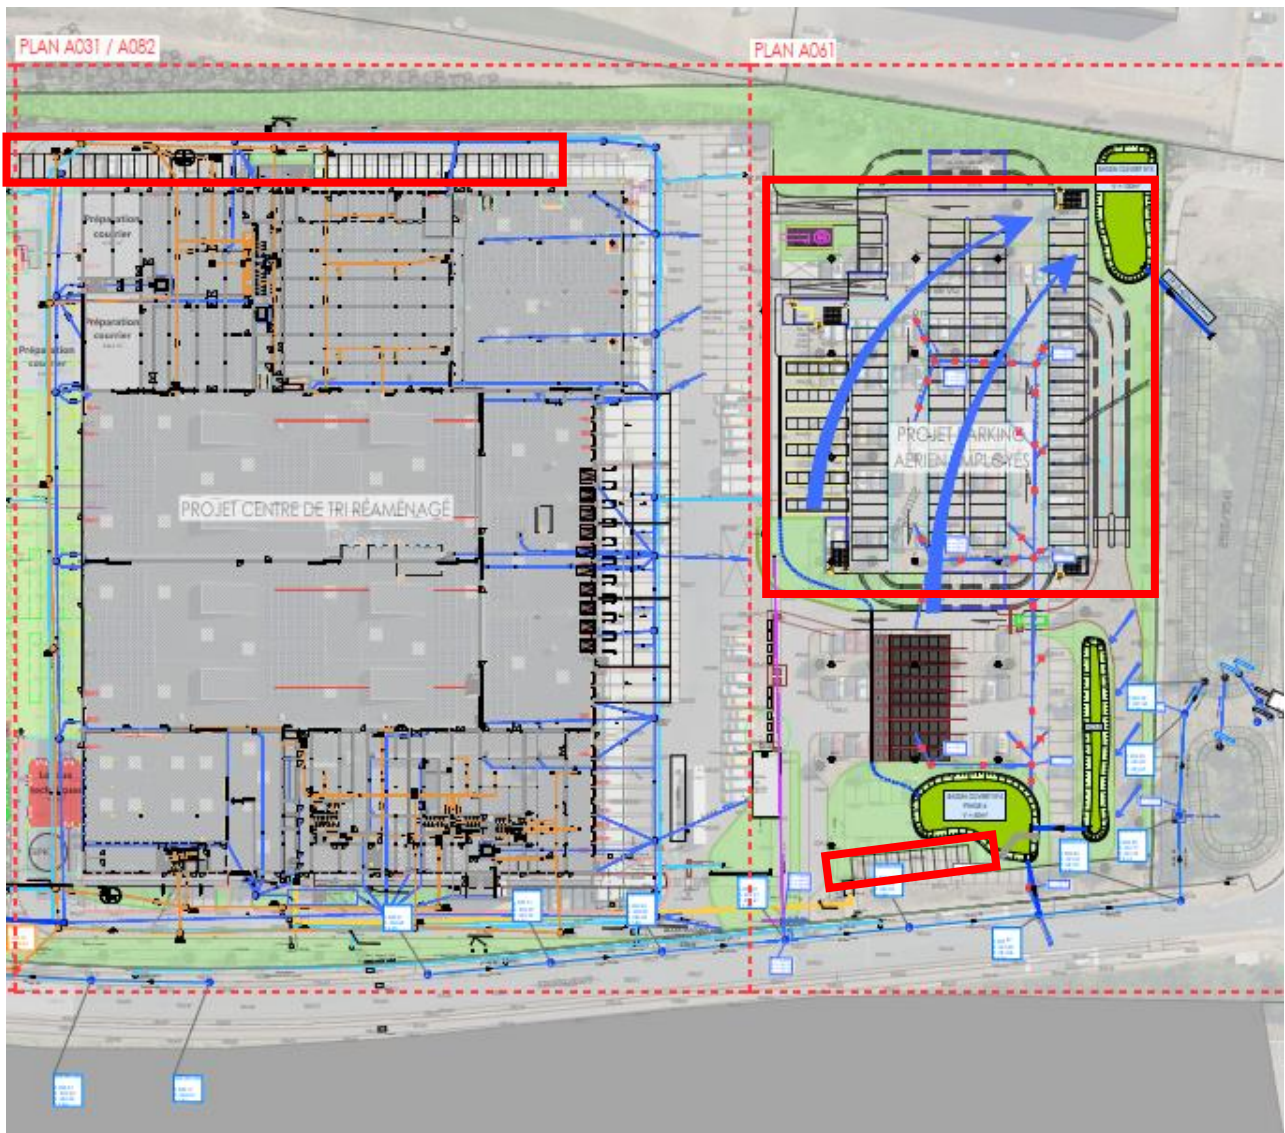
Ausschnitt Plan – concept d’assainissement (Quelle: LSC360 2025). Größere Darstellung im Anhang
